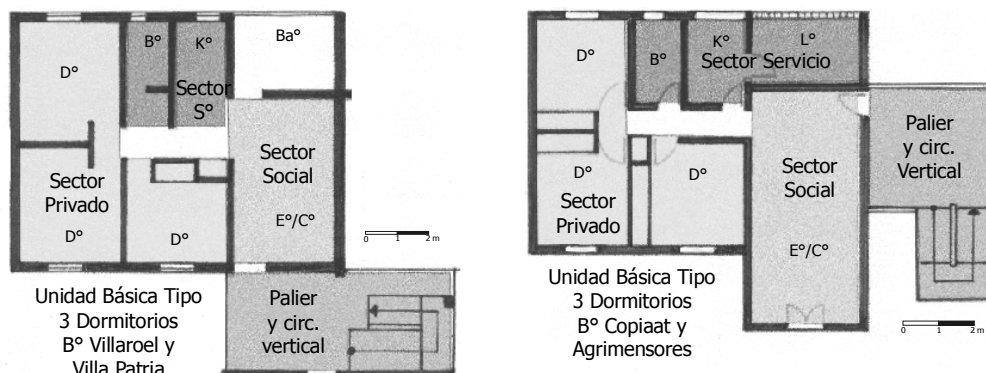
Plantas tipo de algunos conjuntos de viviendas IPV relevados
